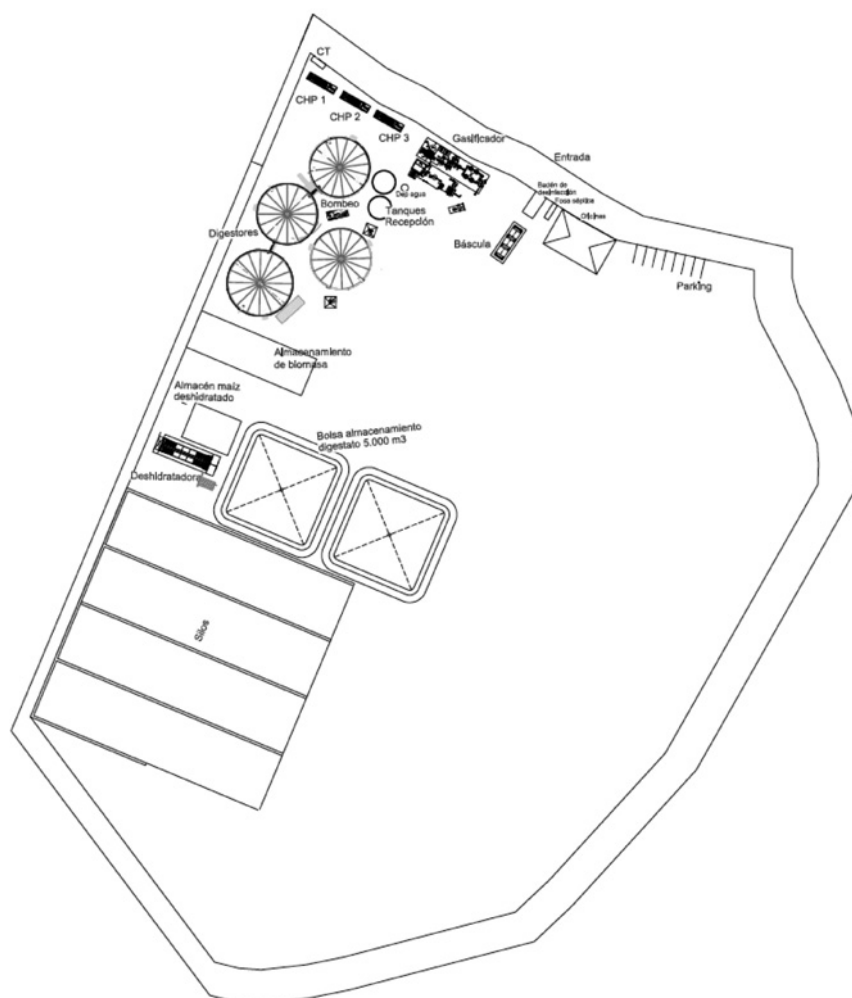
Plano en planta de la instalación en el que se muestra la ubicación de las instalaciones y de los equipos principales.
